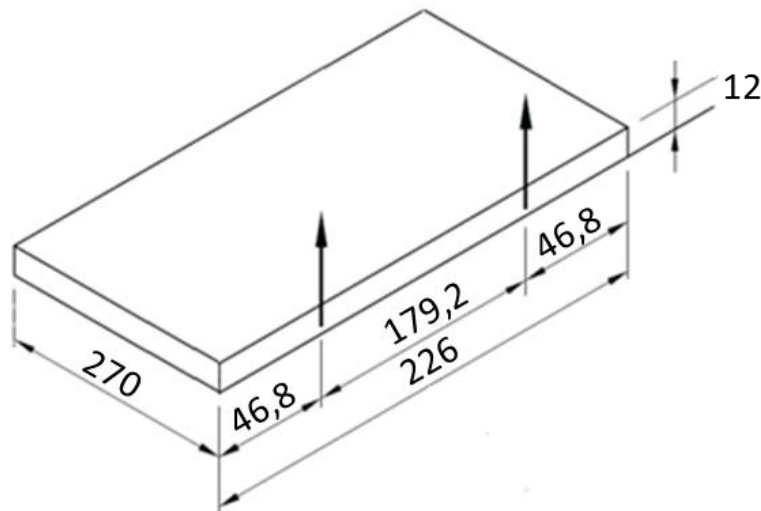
Posicionamento dos pontos para desmoldagem, dimensões em cm.
